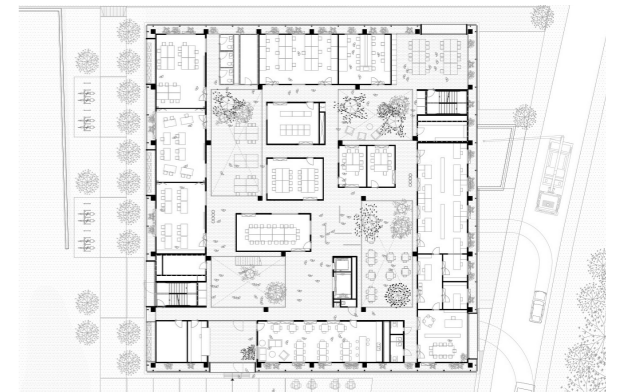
| Sobredimensionado de la estructura y disposición de cajas interiores.
